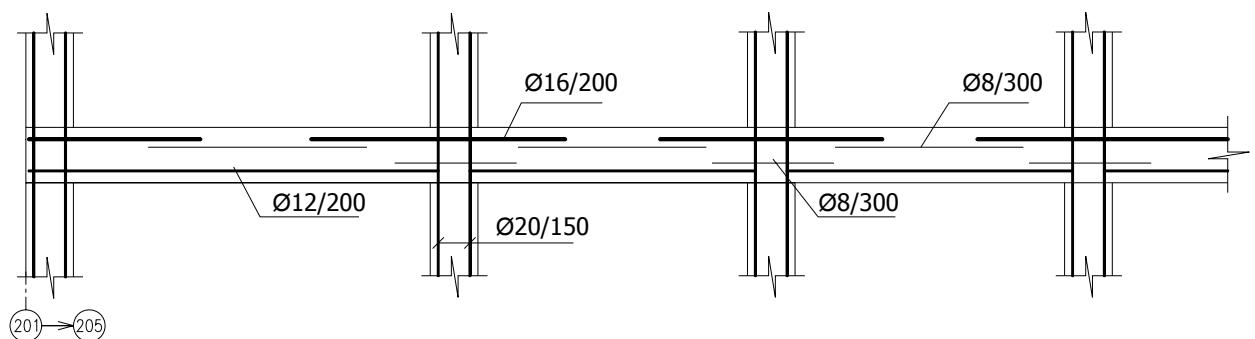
Фрагмент верхнего армирования плиты перекрытия
